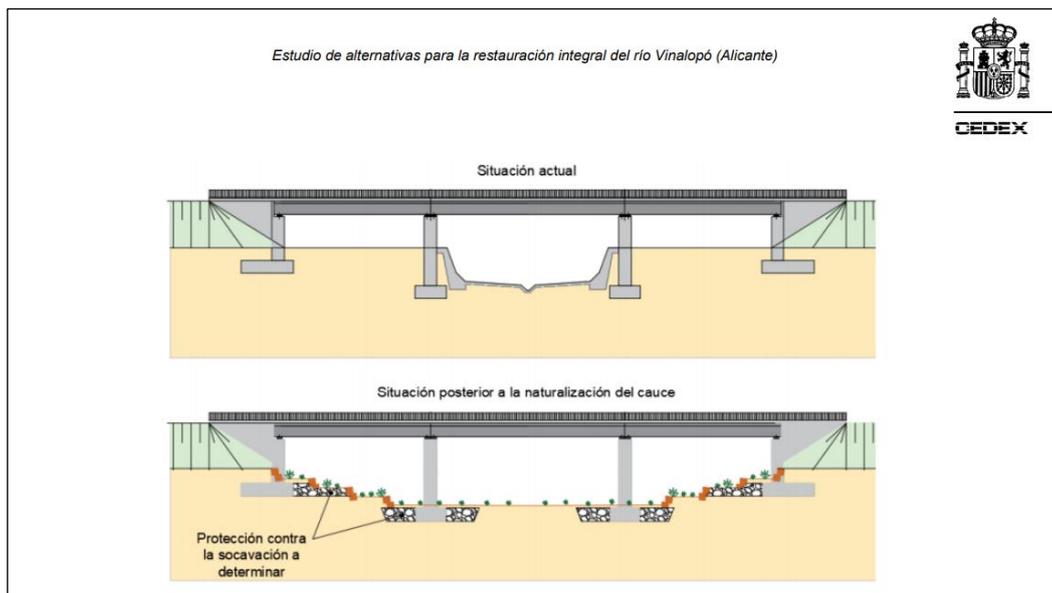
Planteamiento del CEDEX de adecuación de cauce hormigonado bajo puente, tras su demolición
